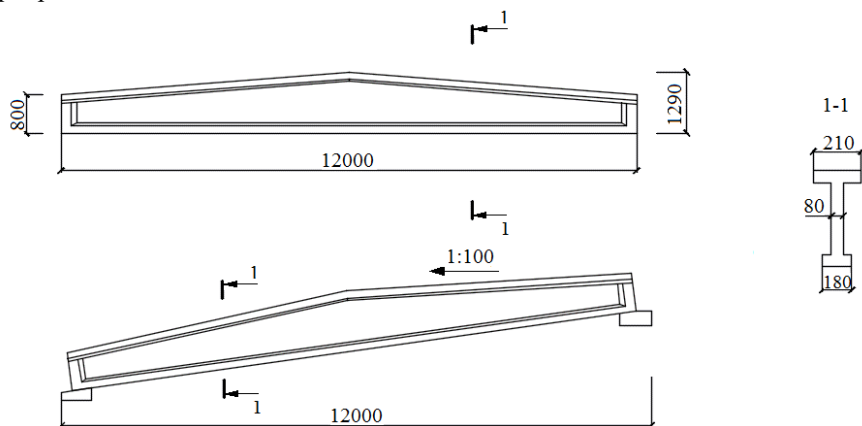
Конструктивная схема балки скатных покрытий пролетом 12 м
